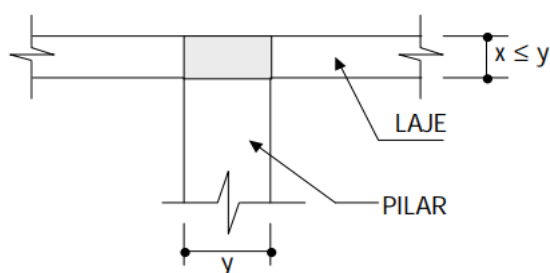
Medidas de x e de y na ligação da laje com o pilar. Fonte: Emerick (2005).
